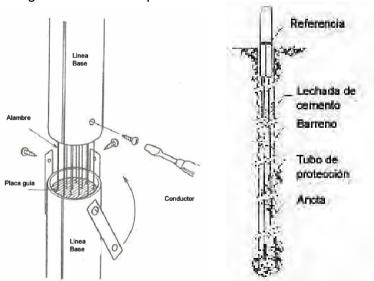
Diagrama de Conexión Detallada del Extensómetro del Barreno Multipunto
